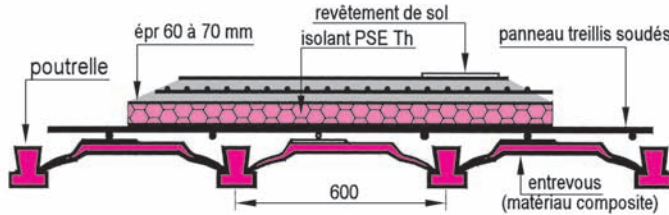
Plancher sur vide sanitaire avec dalle flottante sur isolant
